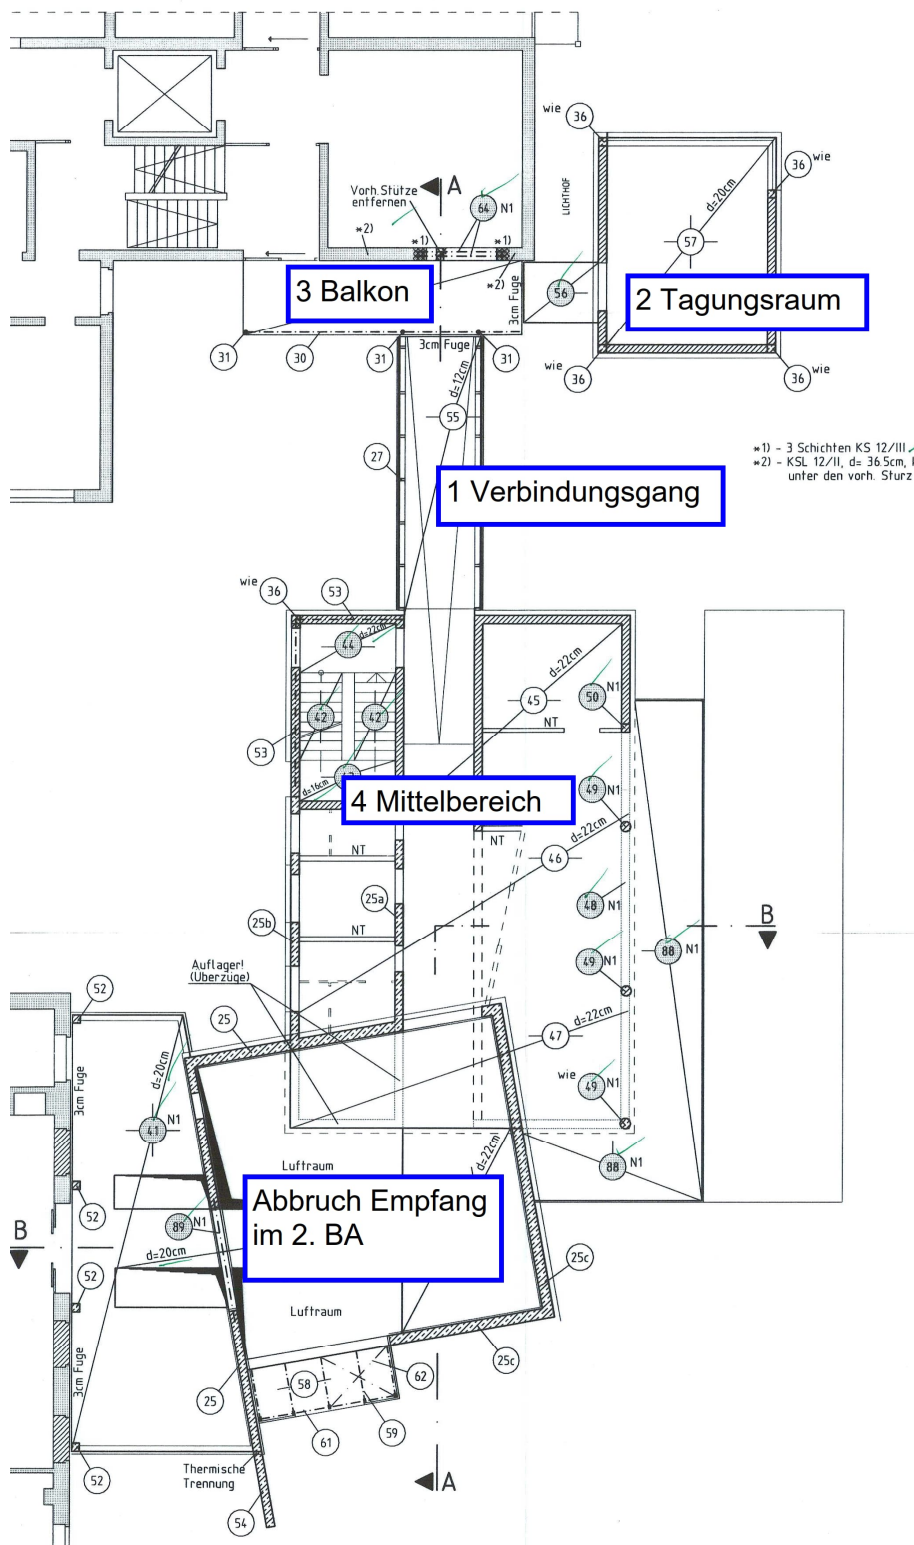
Auszug aus dem Positionsplan P3a Erdgeschoss vom 24.02.03
